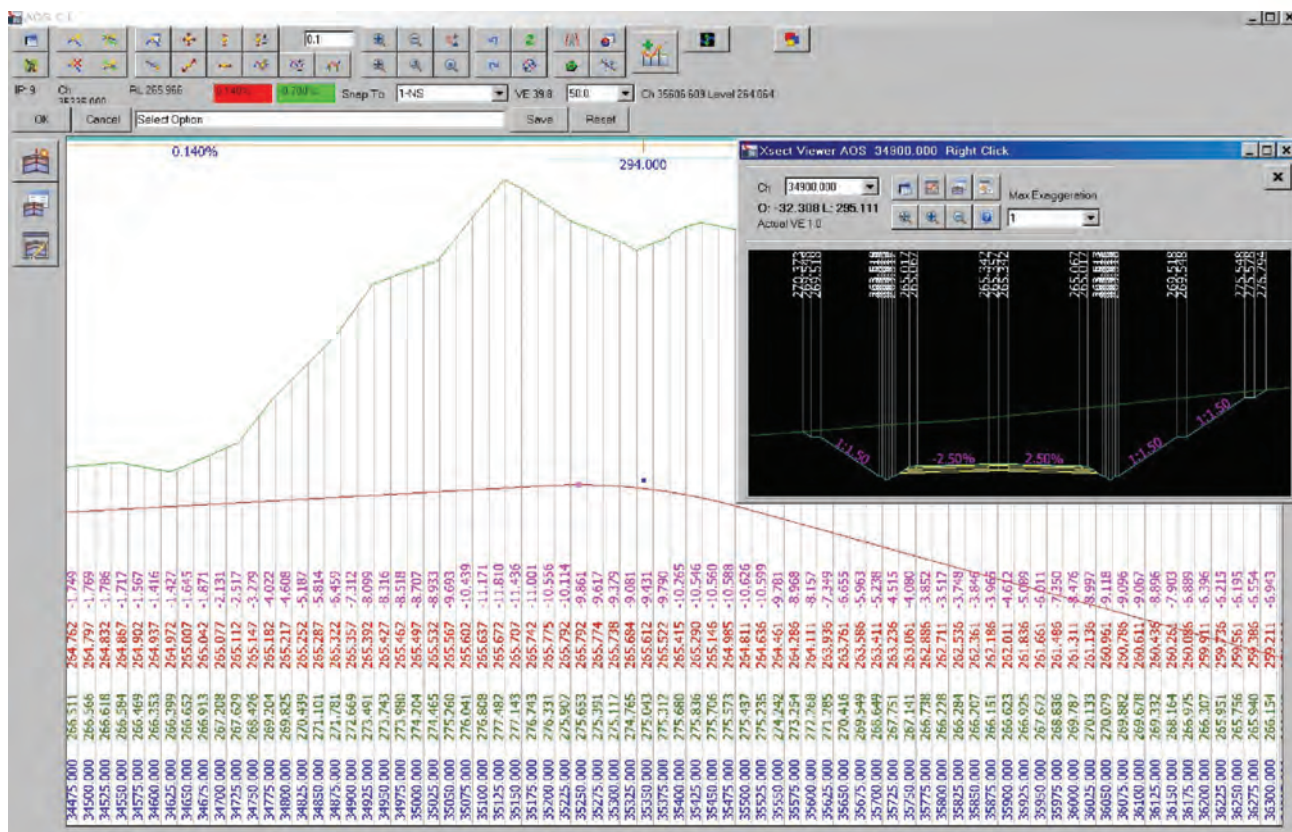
Vizualizare profil longitudinal și secțiune transversală
